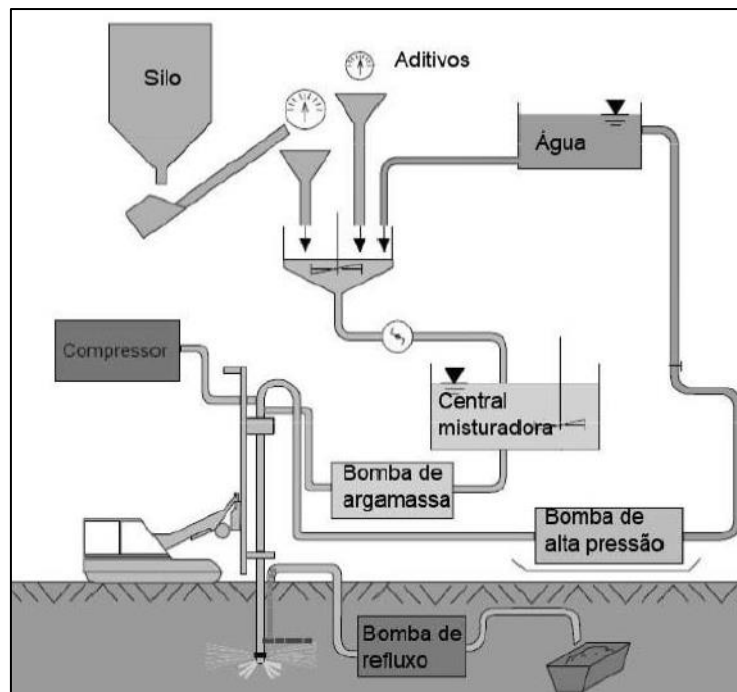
Sistema de equipamentos de *jet-grouting* utilizados em um estaleiro (Fonte: PINTO, 2010).
